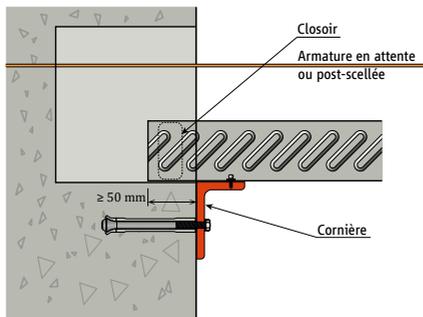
Liaison d'une dalle mixte sur un voile en béton armé par une engravure
